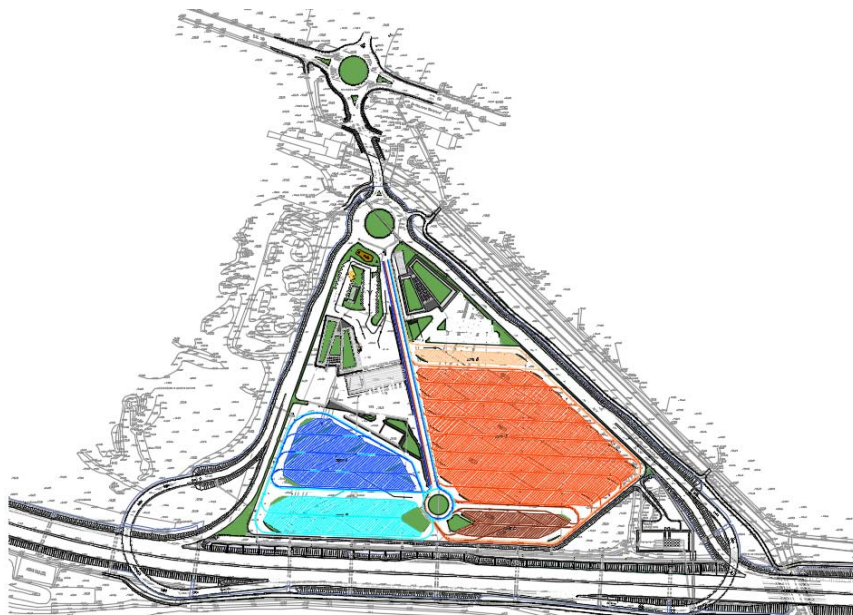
Pianta distribuzione aree parcheggio mezzi pesanti
